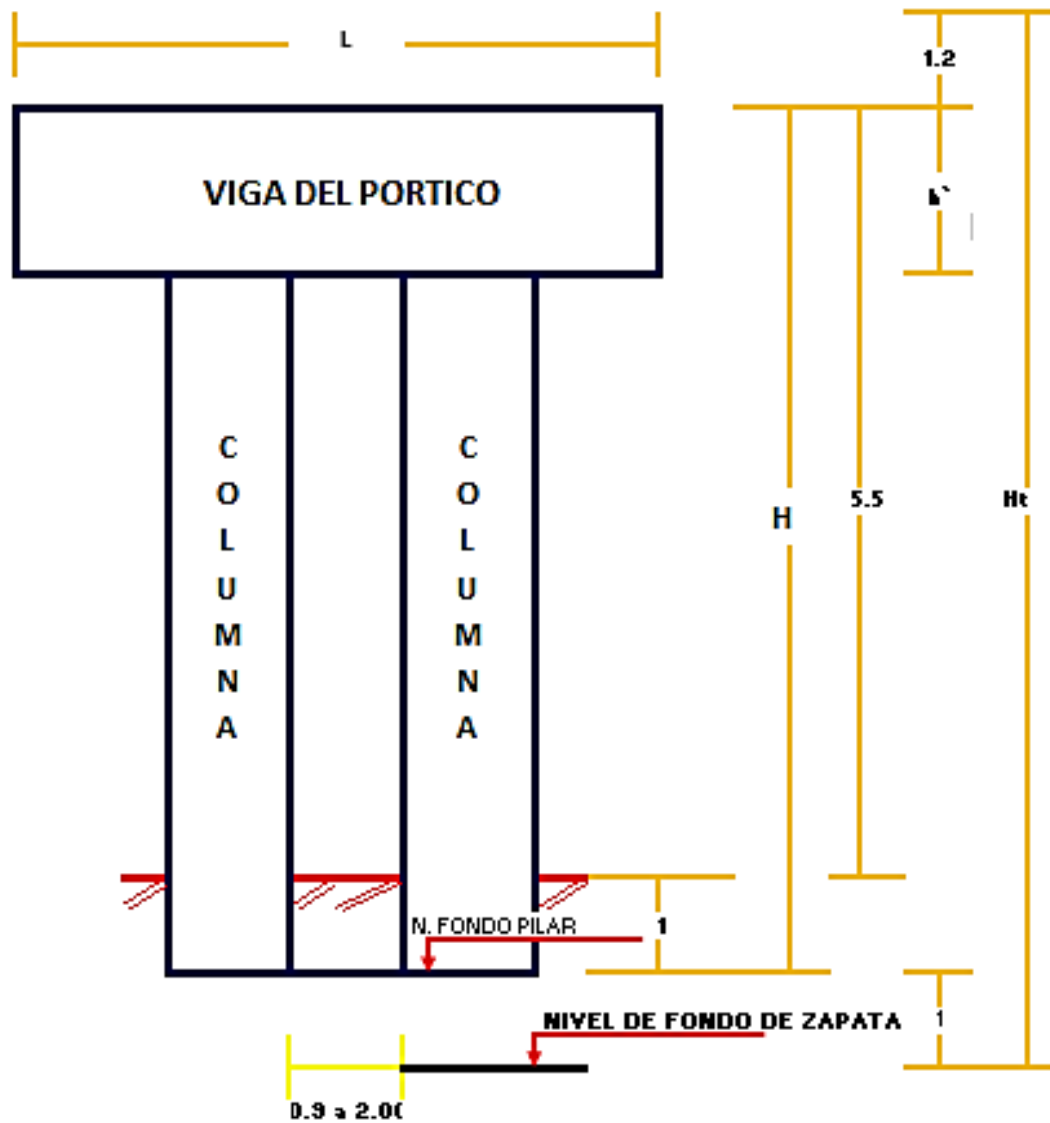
SECCION PILAR-FUENTE: ELABORACION PROPIA
